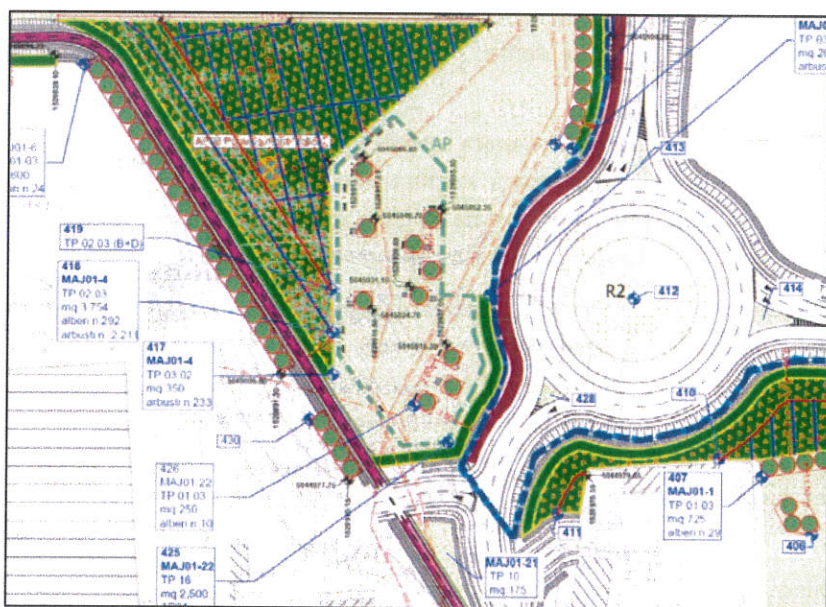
PROGETTO ESECUTIVO- PLANIMETRIA DI INTERVENTO DITTA CASTEL
